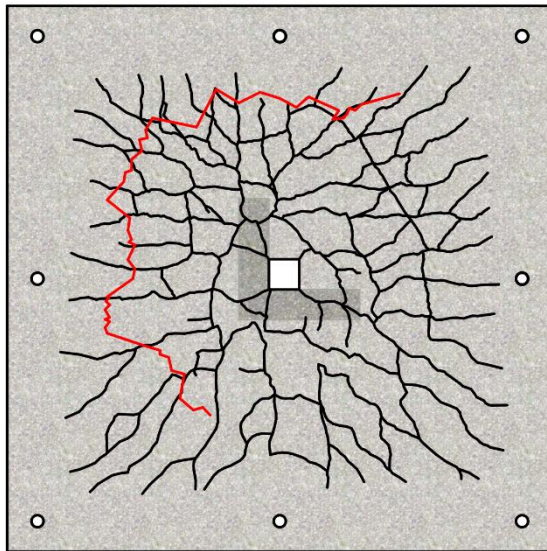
Padrão de fissuração da laje L1
